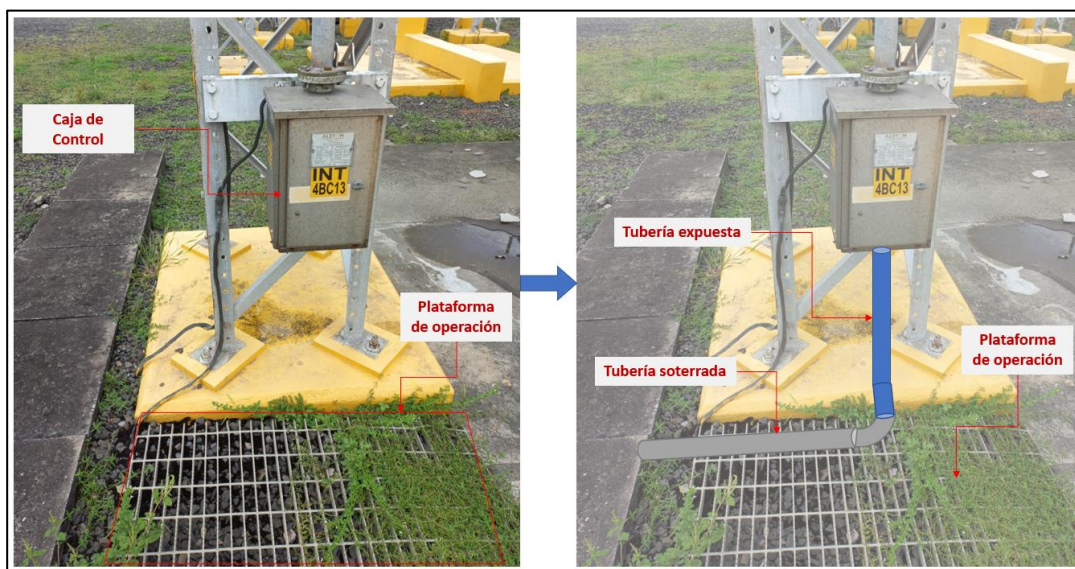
Concepto de instalación de tubería para CU 4BC13
